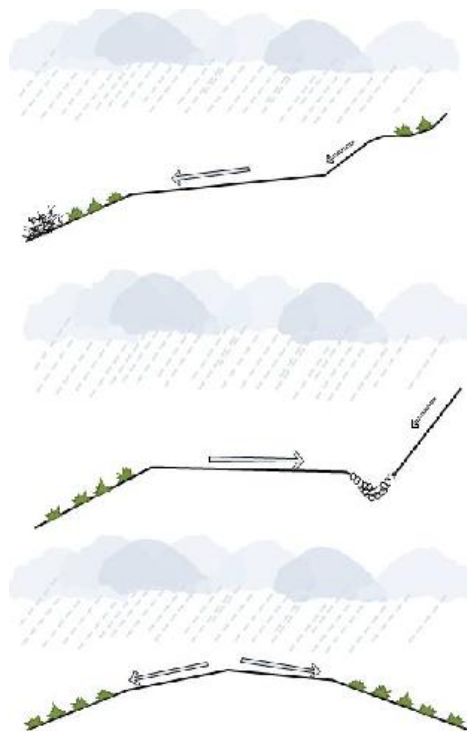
Perfil transversal da estrada: a) Perfil inclinado para o exterior; b) Perfil inclinado para o interior; c) Perfil em “V” invertido (Fortunato et al., 2013)
